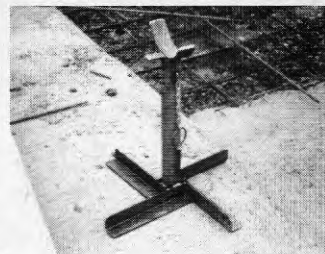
Stöd för PVC-slasrörets ände. Kan alternativt vara fastspänt på röret
